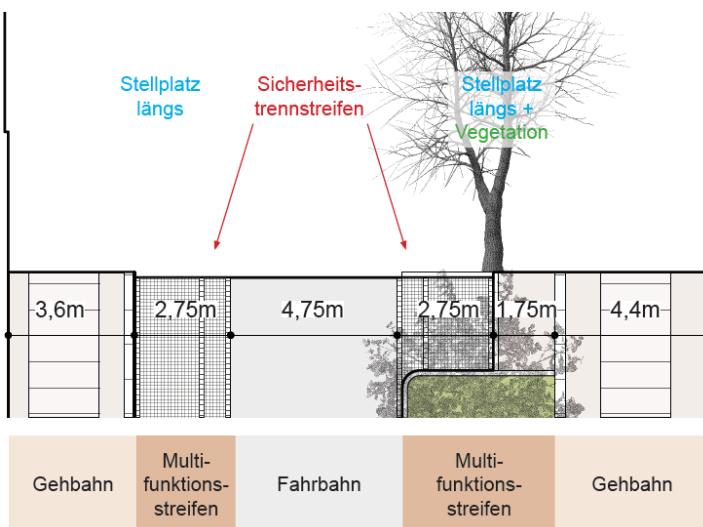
Fahrradstraße Kochstraße – Abschnitte mit Baumbestand, Prinzipschnitt mit Draufsicht
